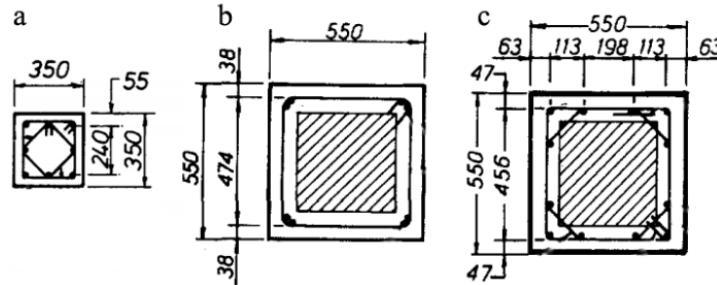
Detalle de la sección transversal de las columnas de Rodríguez y Park (1994): a) columna original, b) encamisado SS1 y SS2, c) encamisado SS3 y SS4
